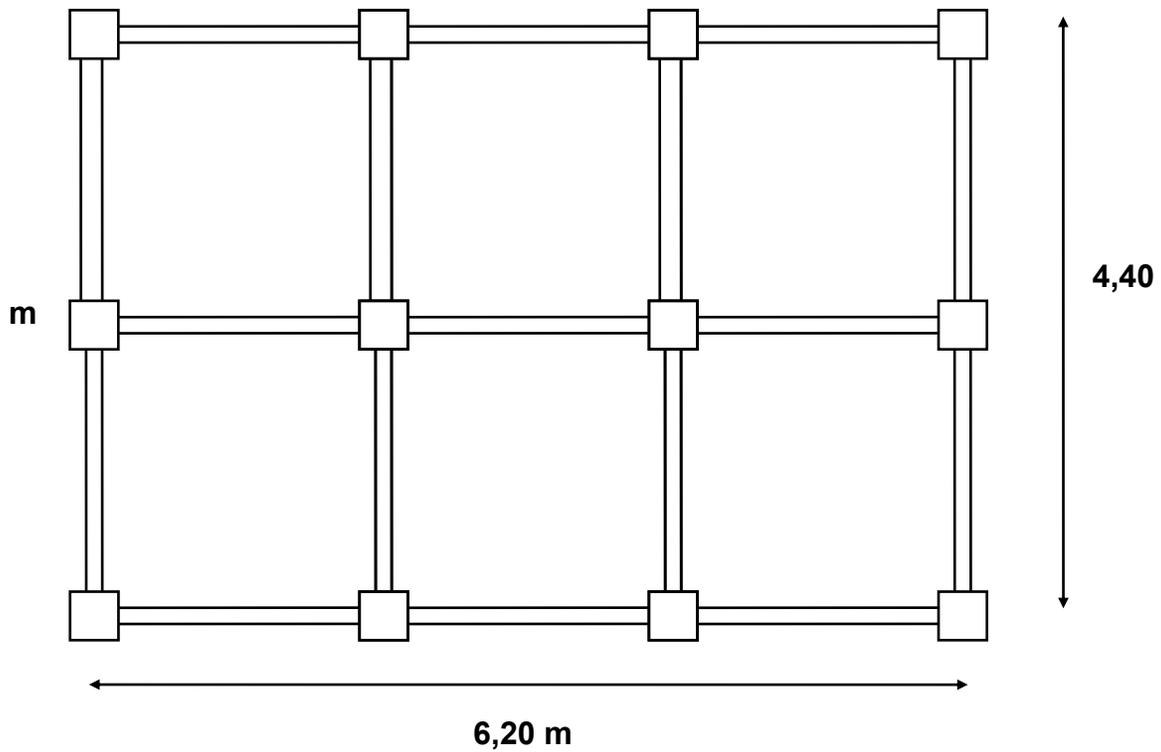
Planta baixa de um paiol para armazenar 400 sacas de milho.
